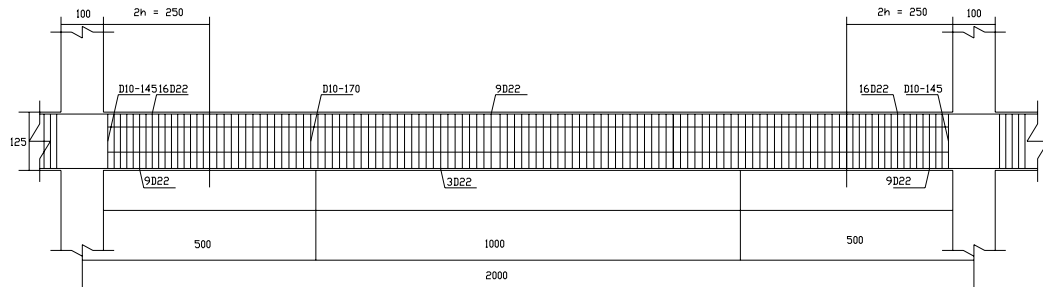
Detail penulangan kolom 100/100 (cm) model 1
